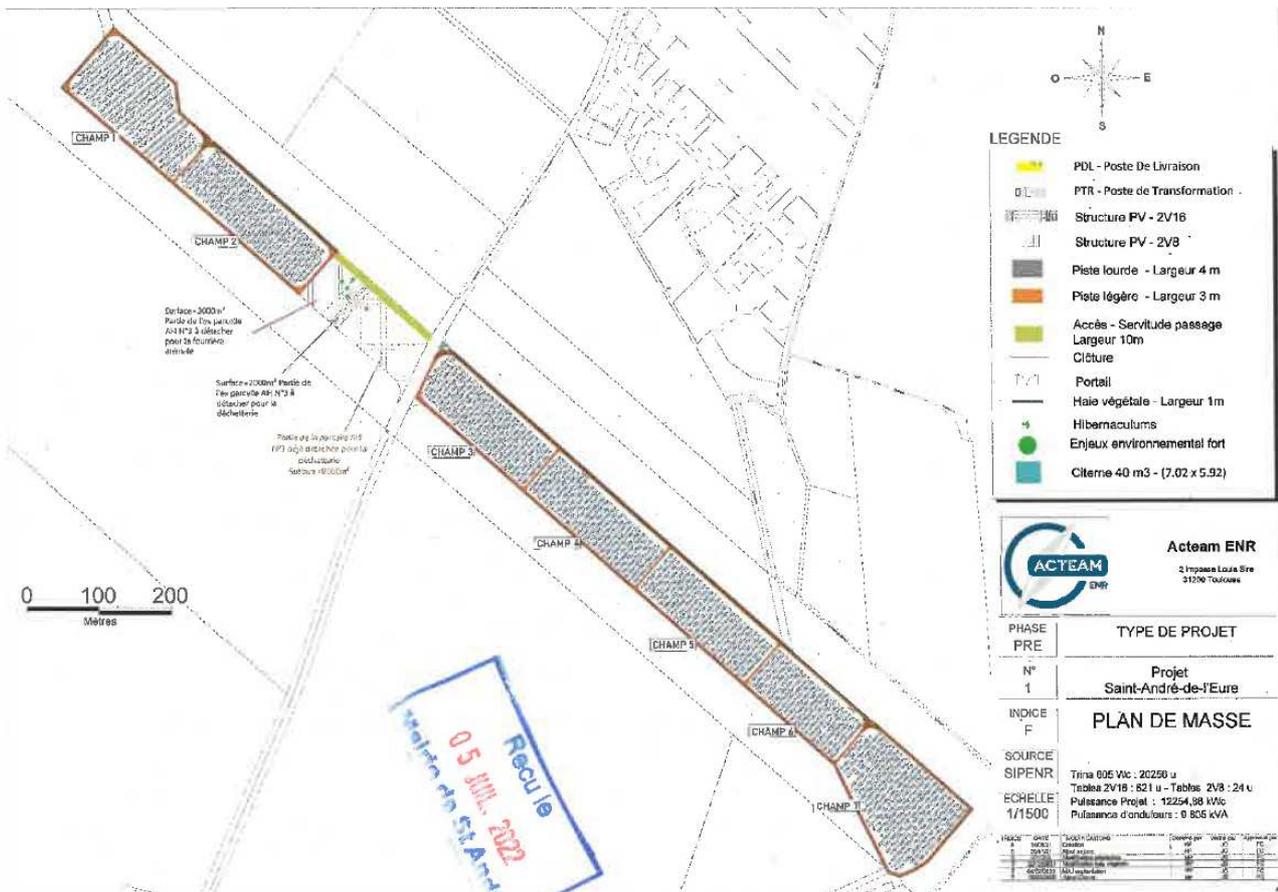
Plan masse du projet de parc photovoltaïque (source : étude d'impact, p. 168)
